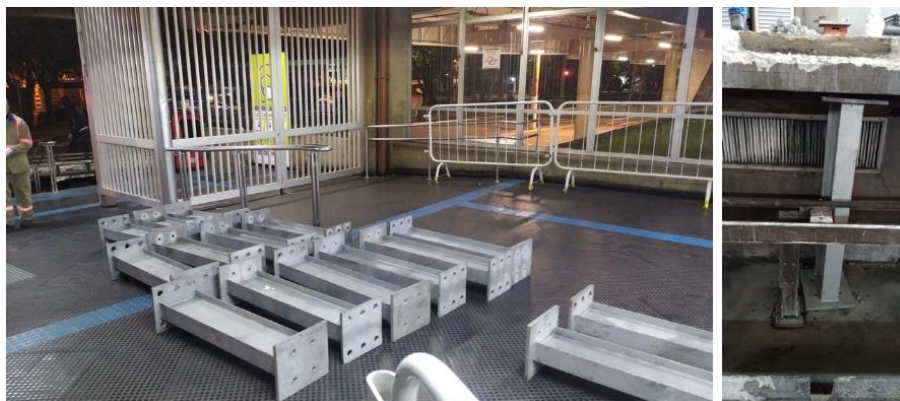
Instalação de pilaretes na estação Tucuruvi
